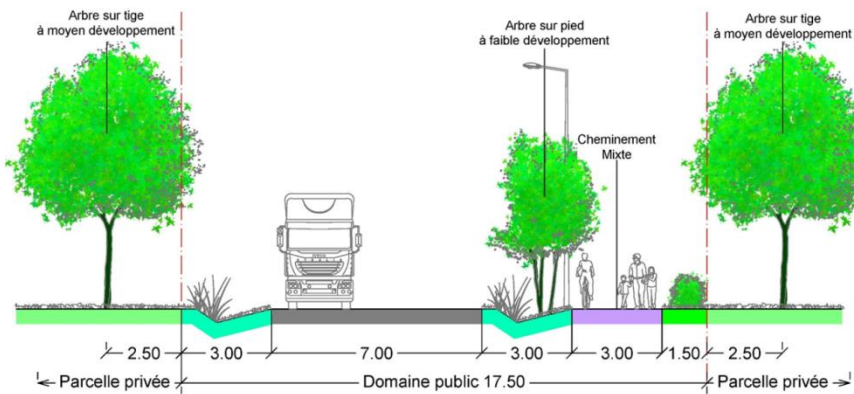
Secteur sud - Coupes de principe des aménagements – Voie de desserte sur 7m
